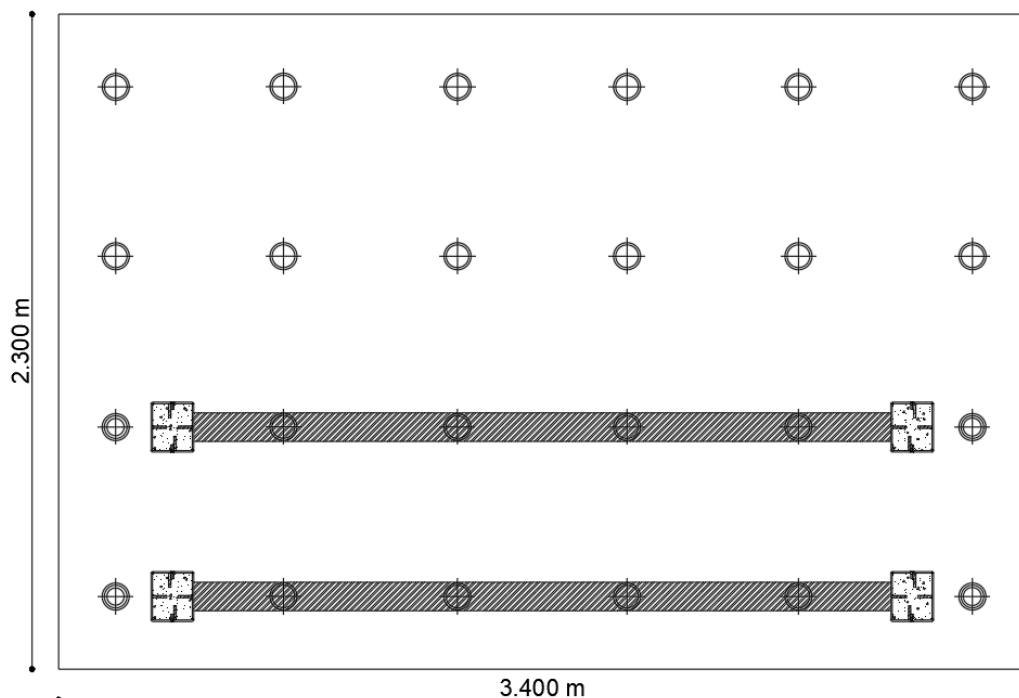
Vista superior losa de cimentación y pernos de anclaje.
